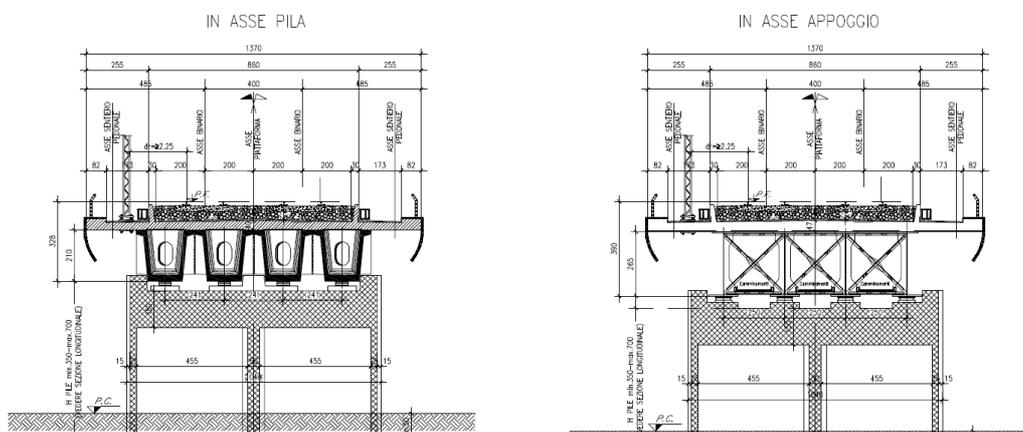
Pila campate 25 - 40 m: sezioni trasversali in asse pila e in asse appoggi
